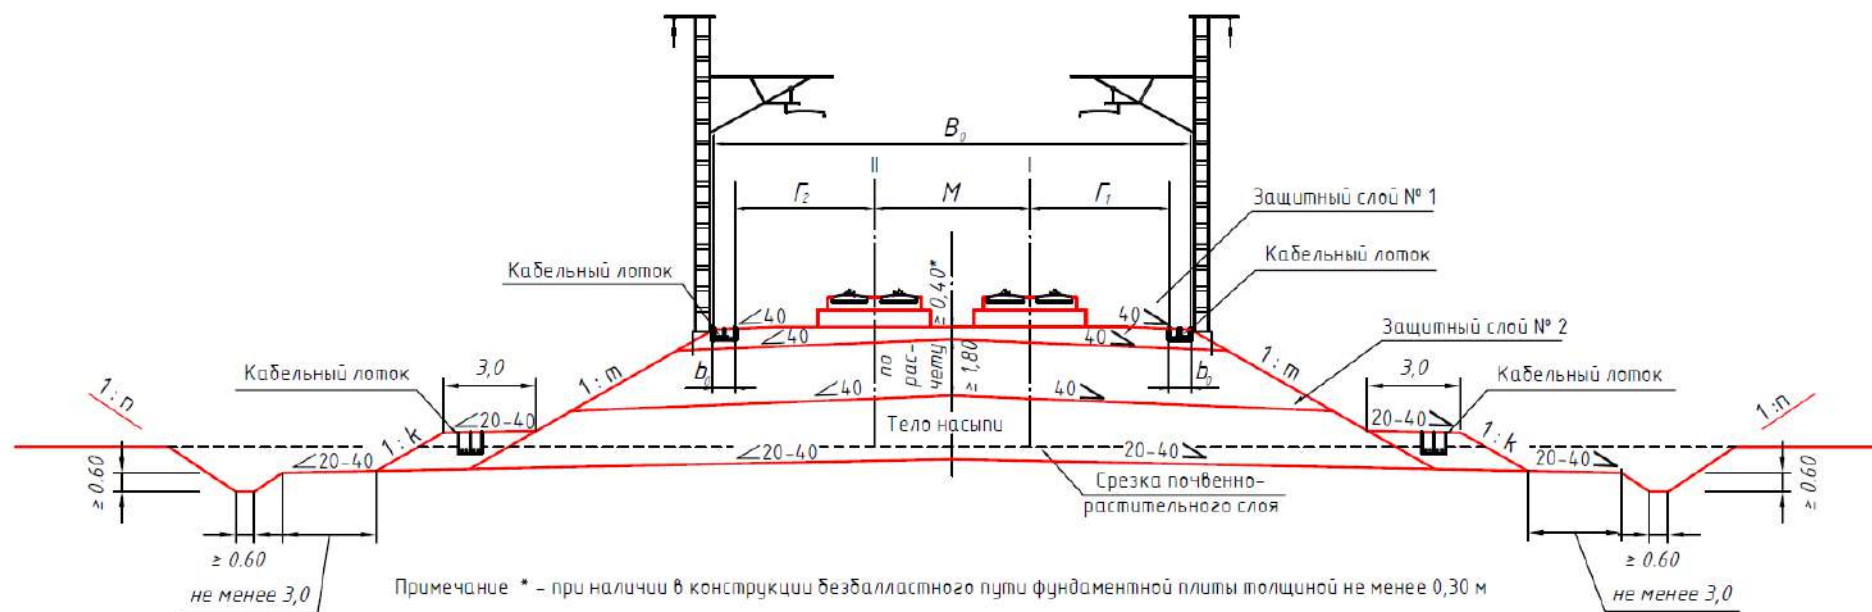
Конструкция насыпи на участке укладки безбалластного верхнего строения пути
